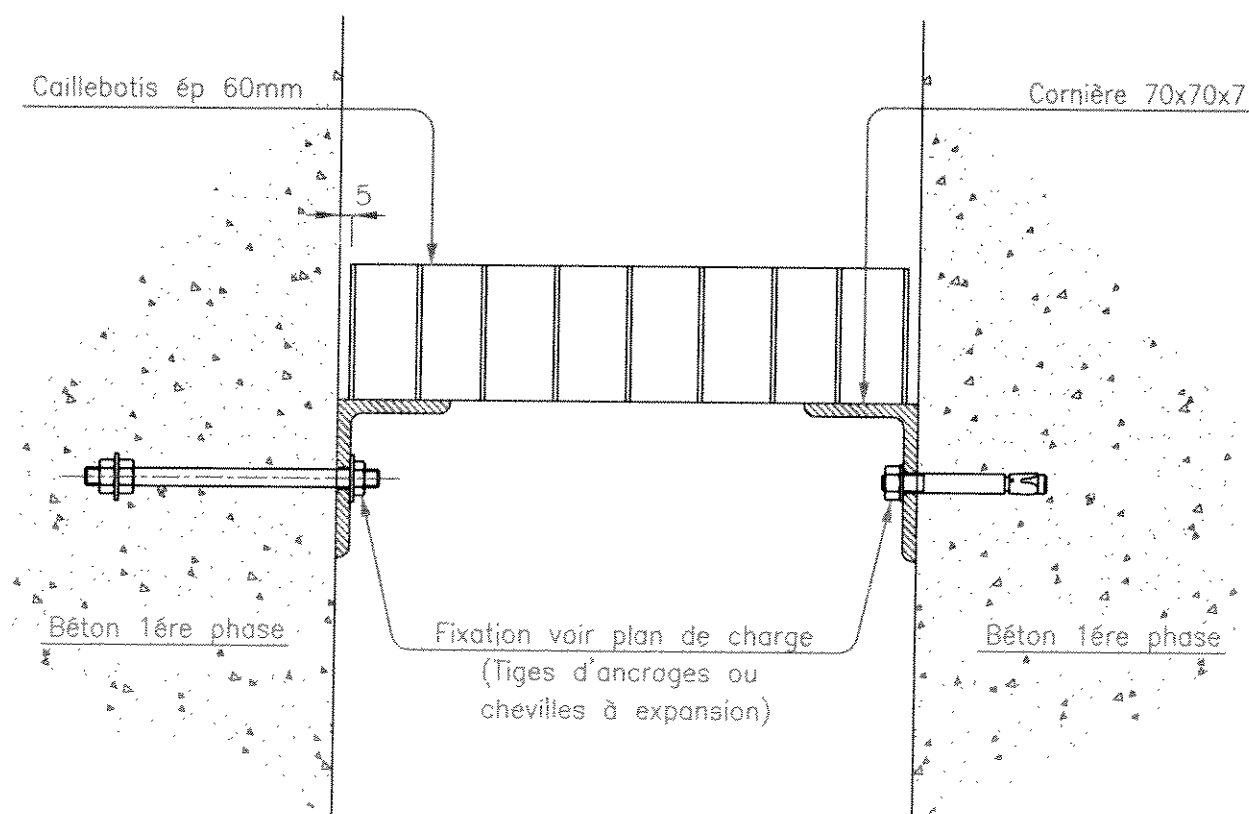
PLATELAGE – BORDURE EN CONSOLE SUR VOILE BETON
